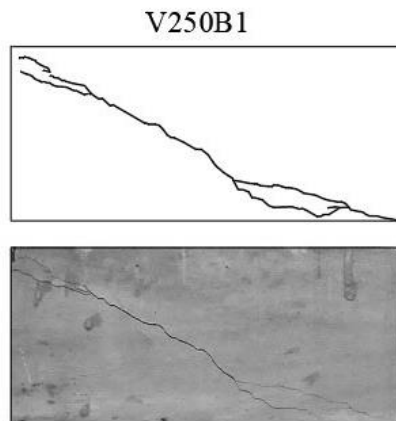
Padrão de fissuração da viga V250B1. Fonte: Autora
